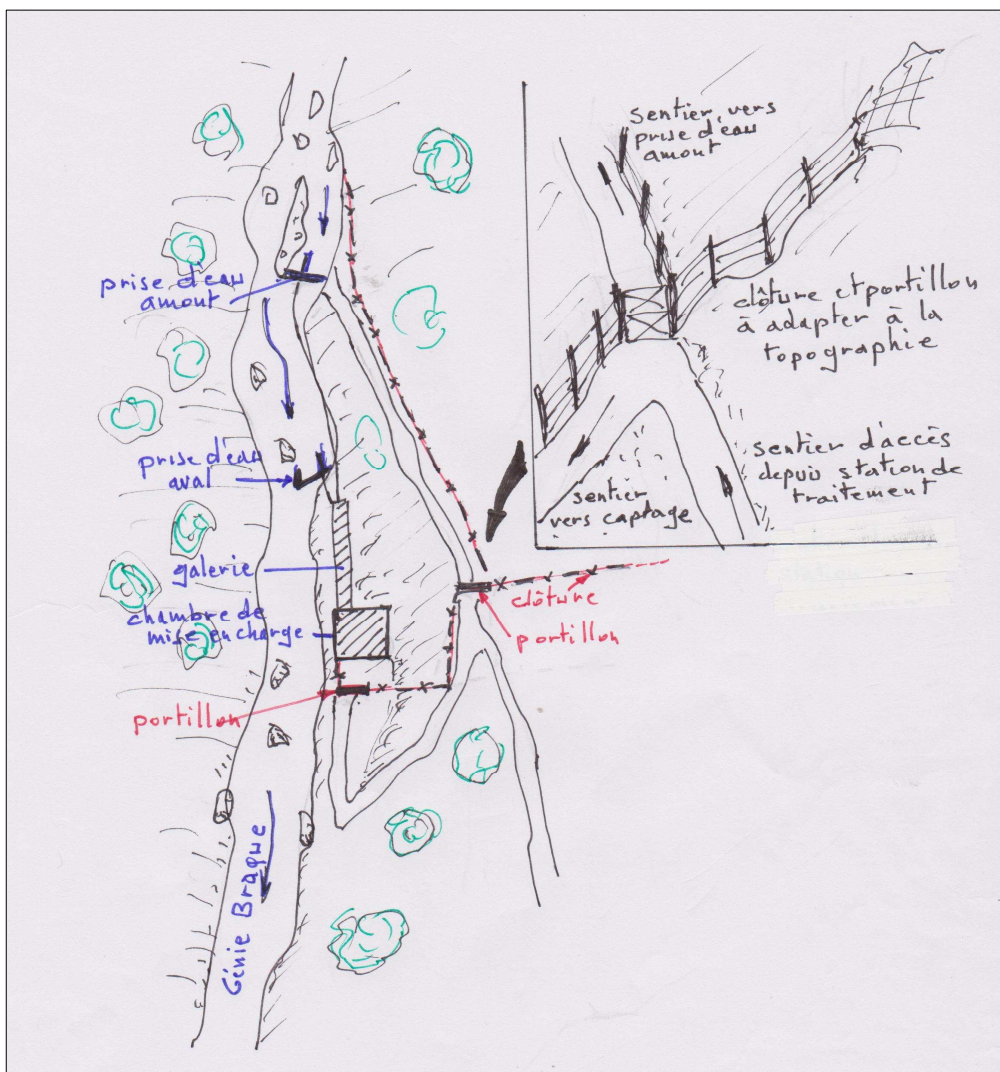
SCHEMA DU SYSTEME DE FERMETURE PROPOSE POUR LE PERIMETRE IMMEDIAT (à gauche plan général, en haut à droite détail de l'aménagement suggéré en partie haute de l'accès)
